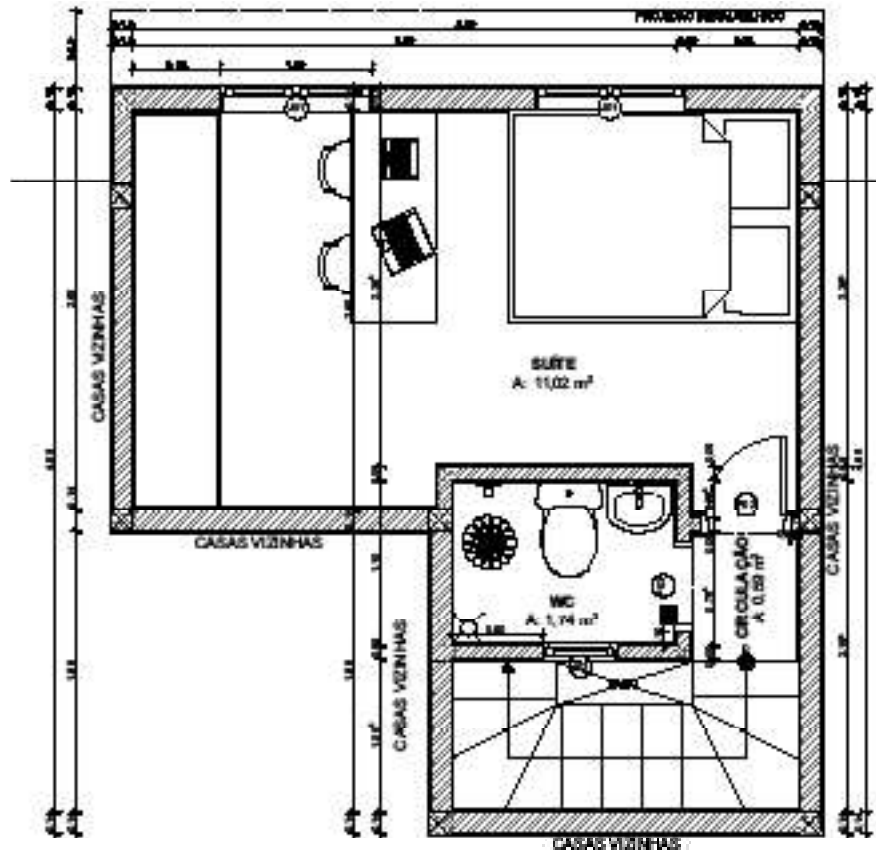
Modificações pavimento térreo última entrega a partir da Opção 1. E:1/50. Fonte: Acervo Taramela.
